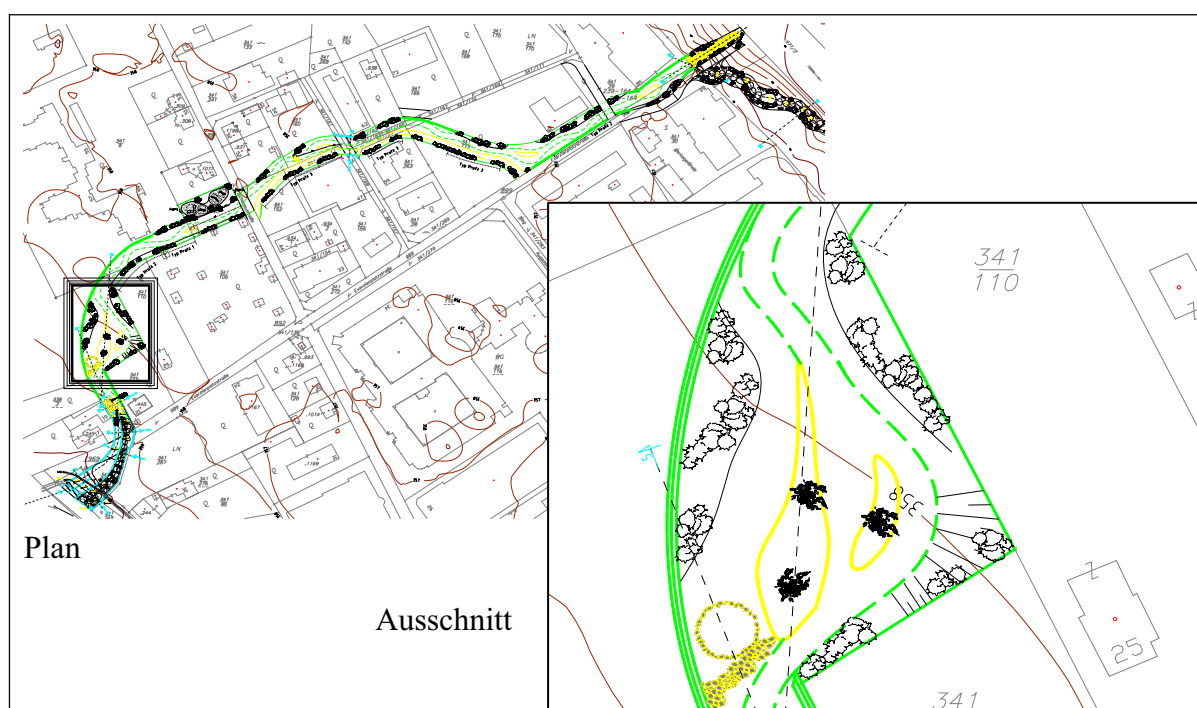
Lageplan, Ausschnitt, Geländeauffüllung – entfallener Vorschlag
